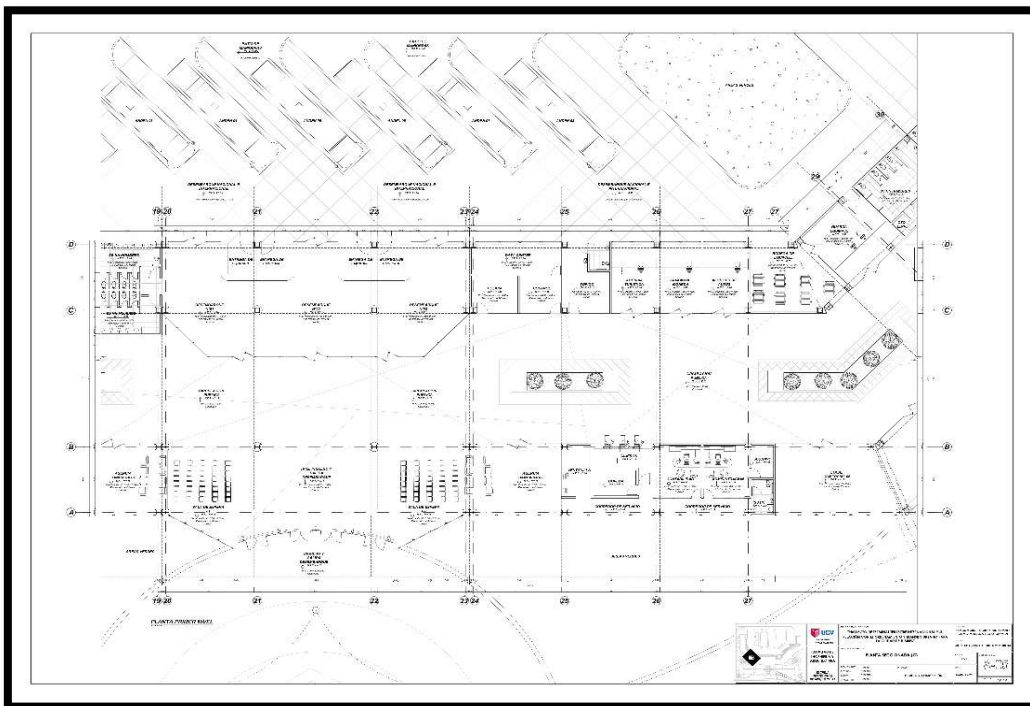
Plano Planta sector (C) Primer Nivel Fuente: *Elaboración Propia.
